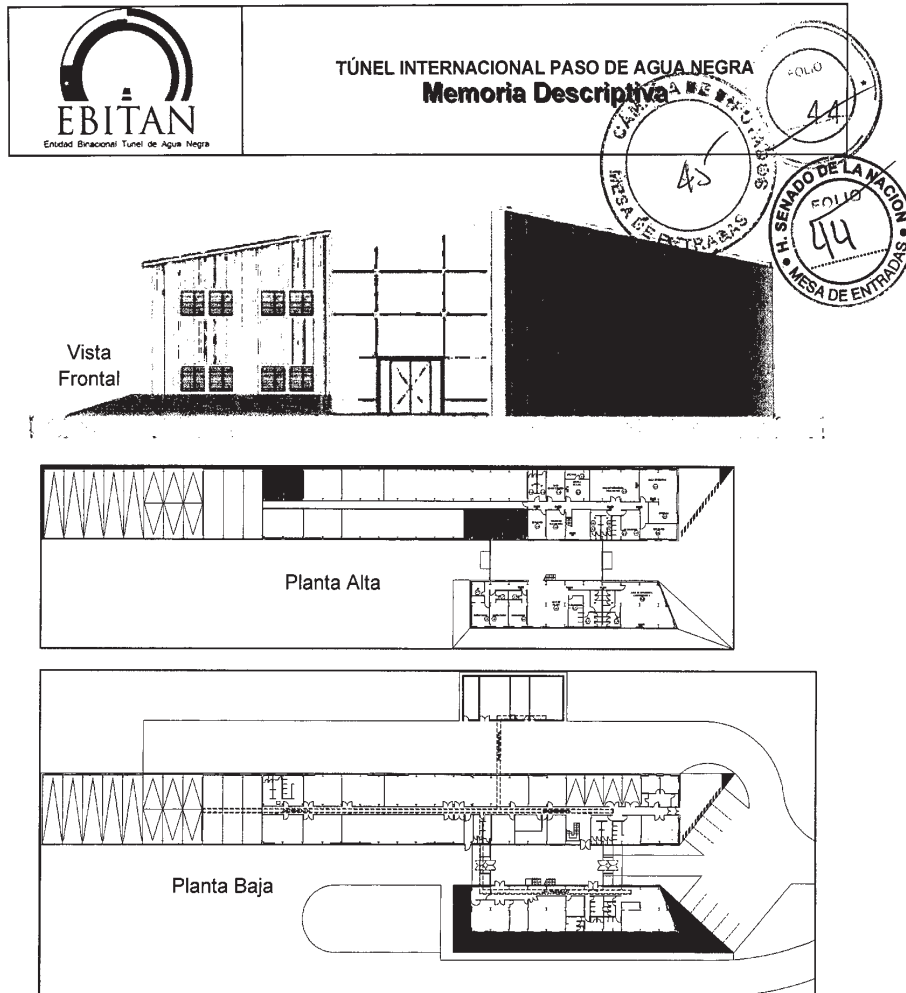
Vista frontal, planta alta y baja del edificio Centro de Control Local
